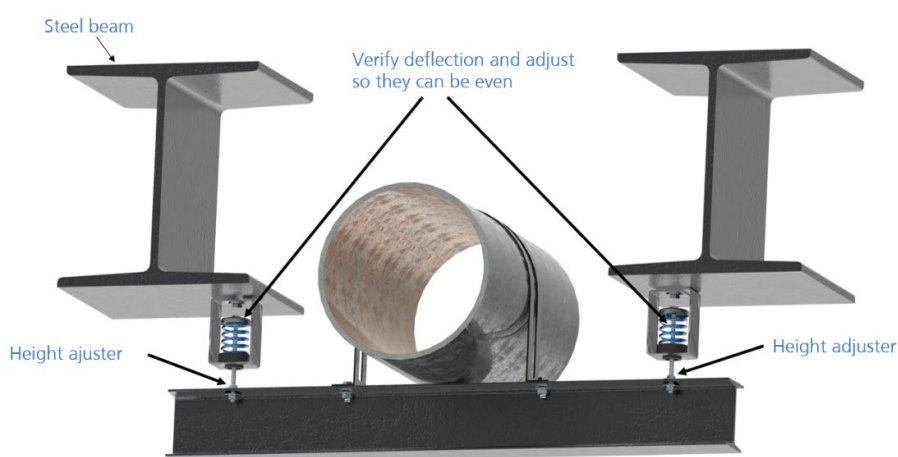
Suspensión del conducto instalando el marco metálico a la viga de acero.
